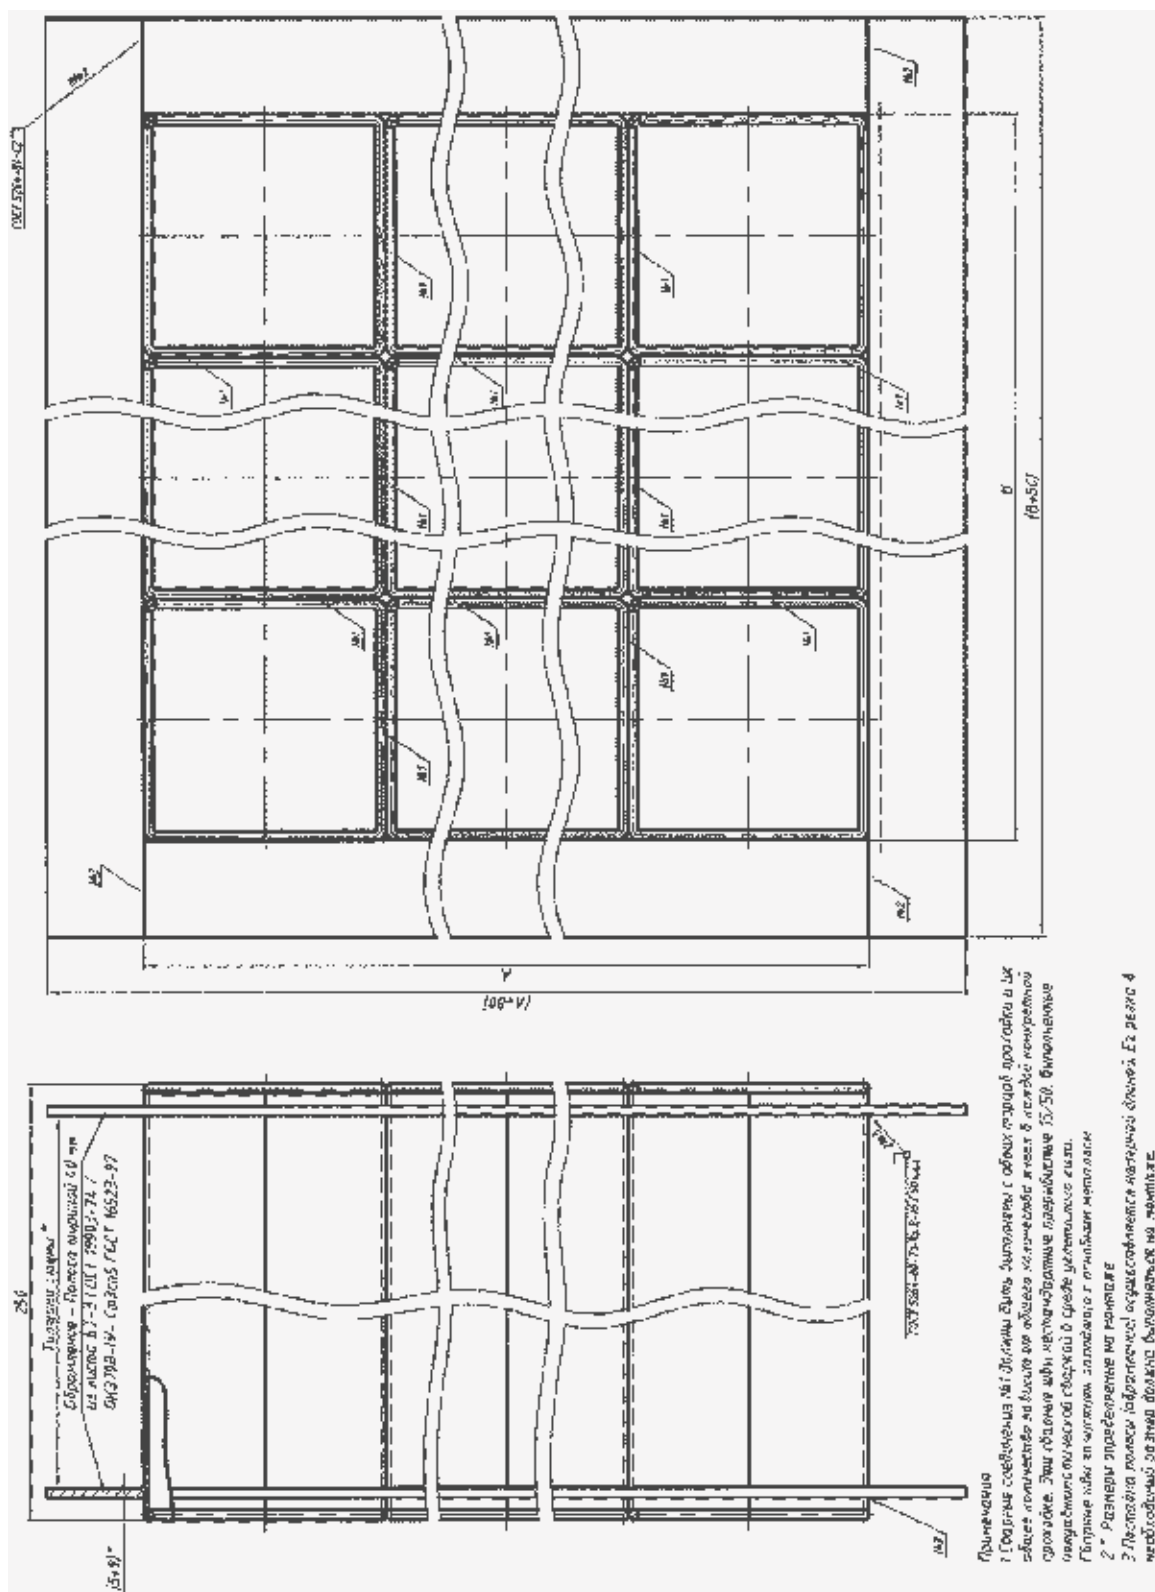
Общий вид блоков проходок коробчатых (его металлоконструкции).
